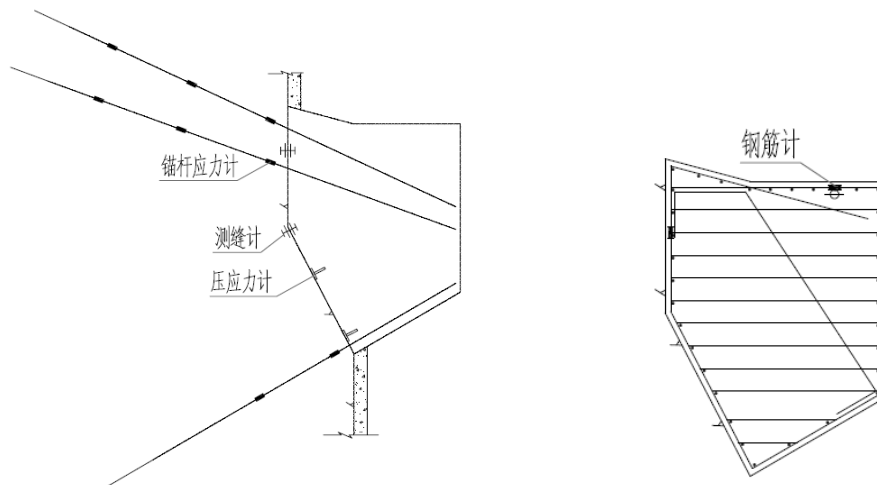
地下厂房岩壁吊车梁典型监测断面图
